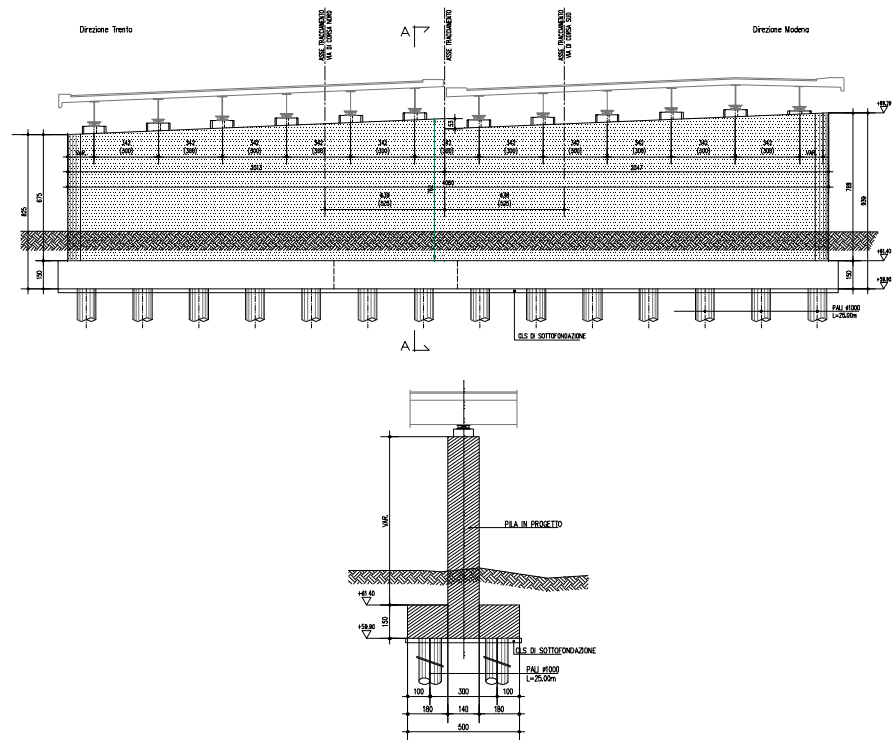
Pila - Sezione in retto impalcato e sezione trasversale
